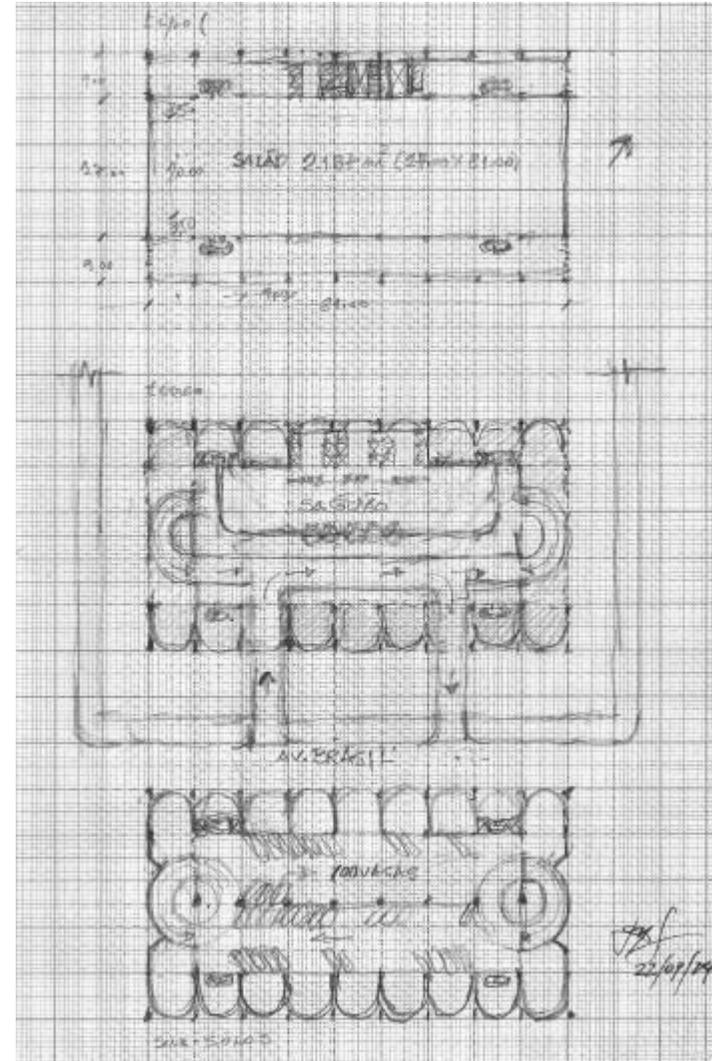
Croquis feitos por Pedro Paulo de Melo Saraiva para a publicação sobre sua obra de autoria do Professor Luis Espallagas Gimenez (2016)
